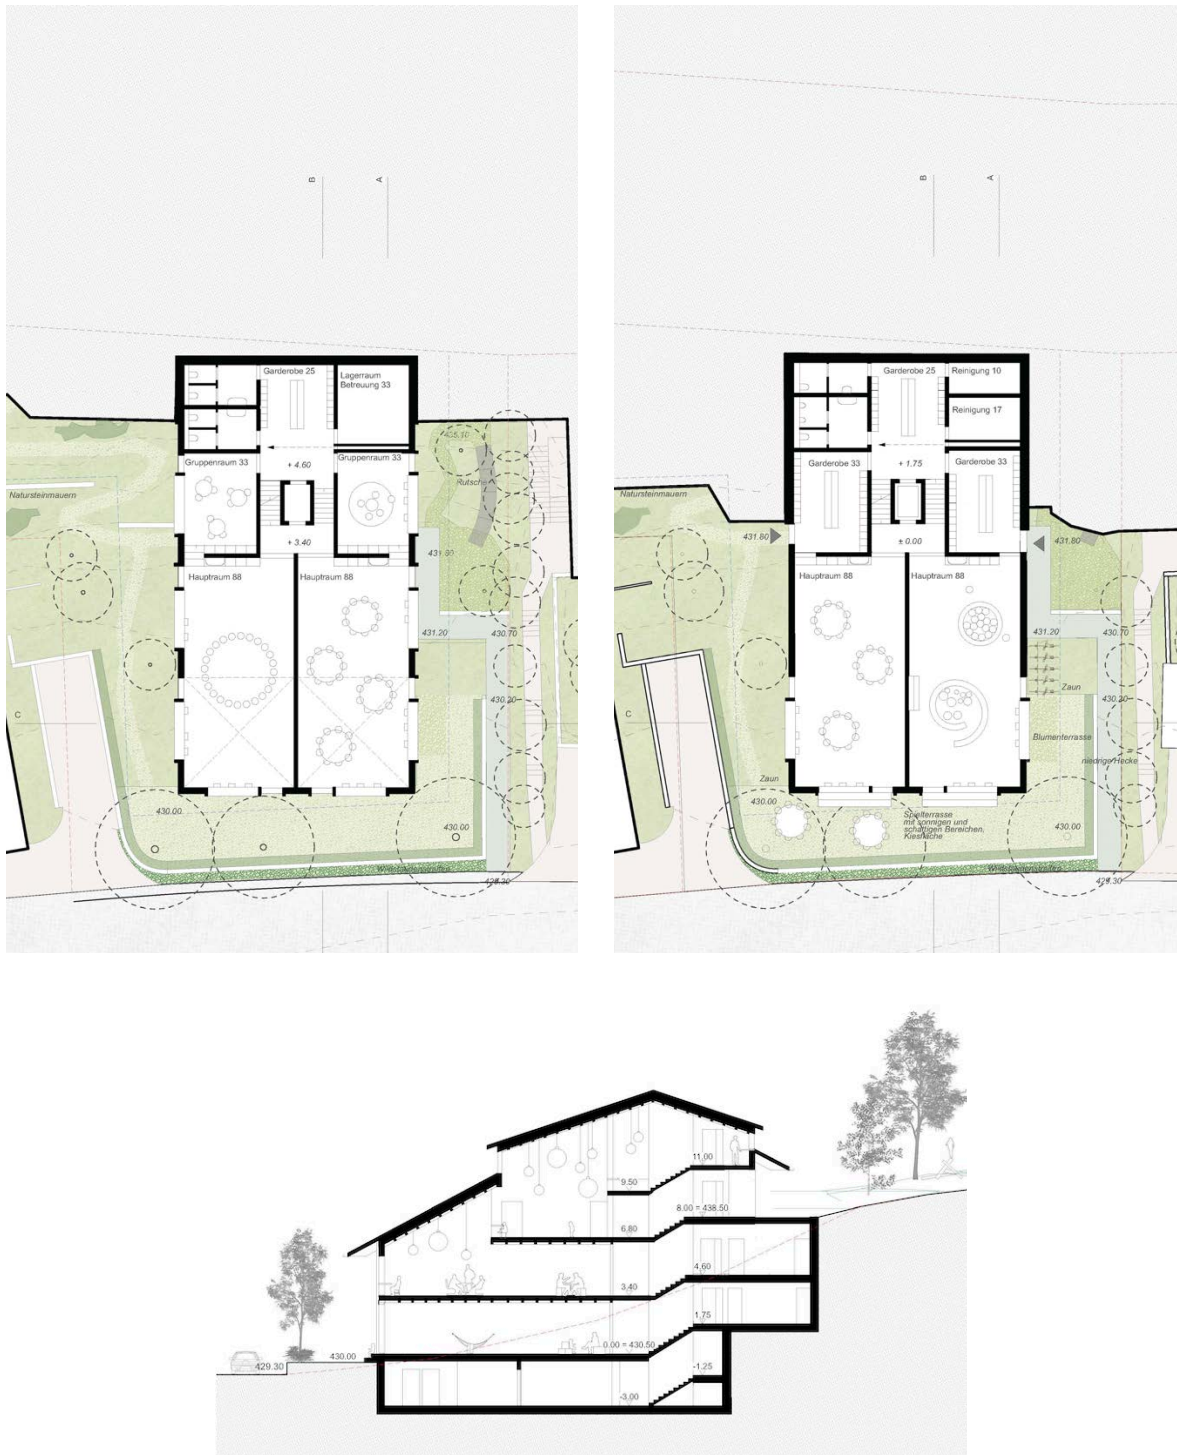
Grundrisse und Schnitt (v. o. l. n. u. r.)
